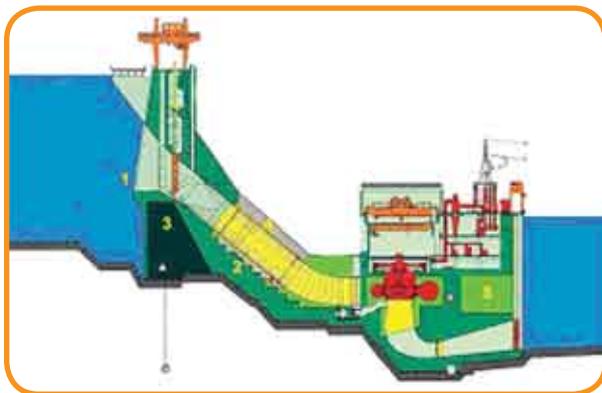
Seção transversal típica das estruturas de concreto da Tomada d'Água – Casa de Força, da 2ª Etapa.
